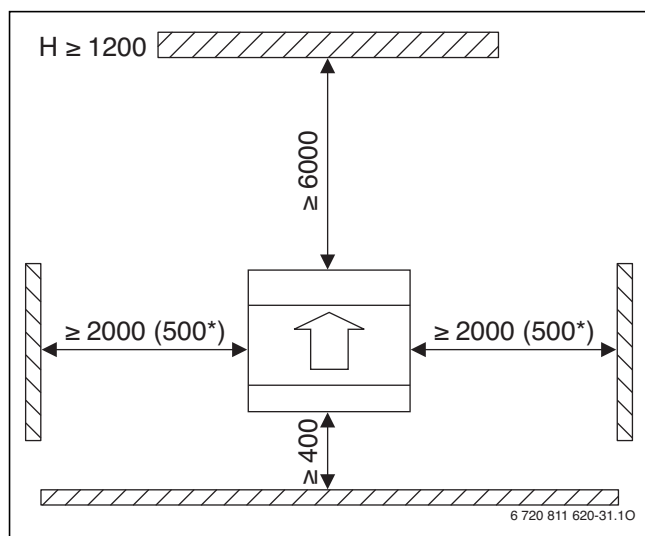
Mindestabstand Wärmepumpe – Umgebung (mm)
